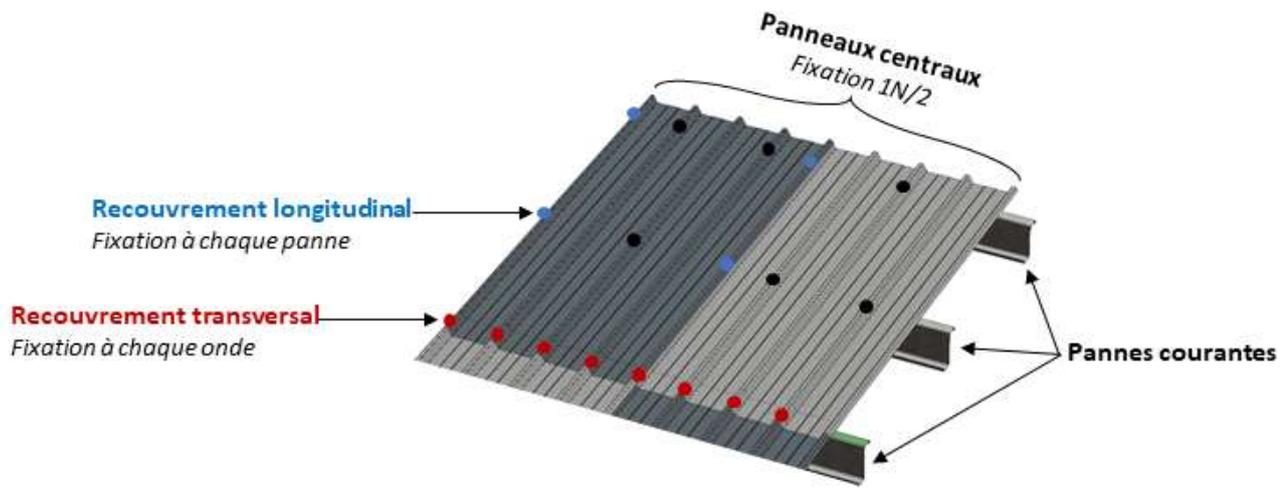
Fixations des panneaux sandwich 1N/2 (voir § 2.4.6.1)
